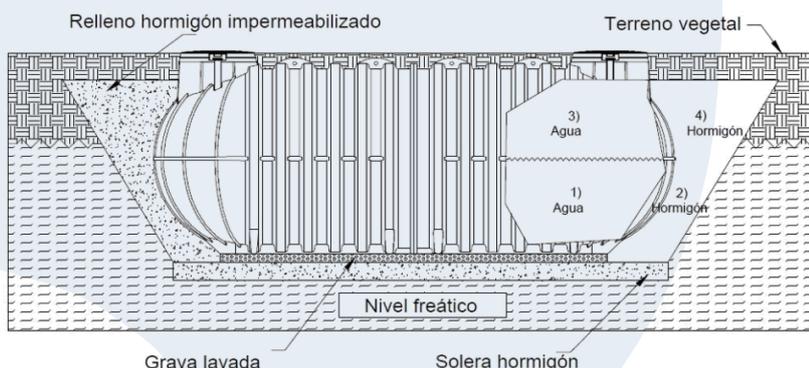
Ilustración VI: Colocación de pozos de registro con losa de hormigón.
